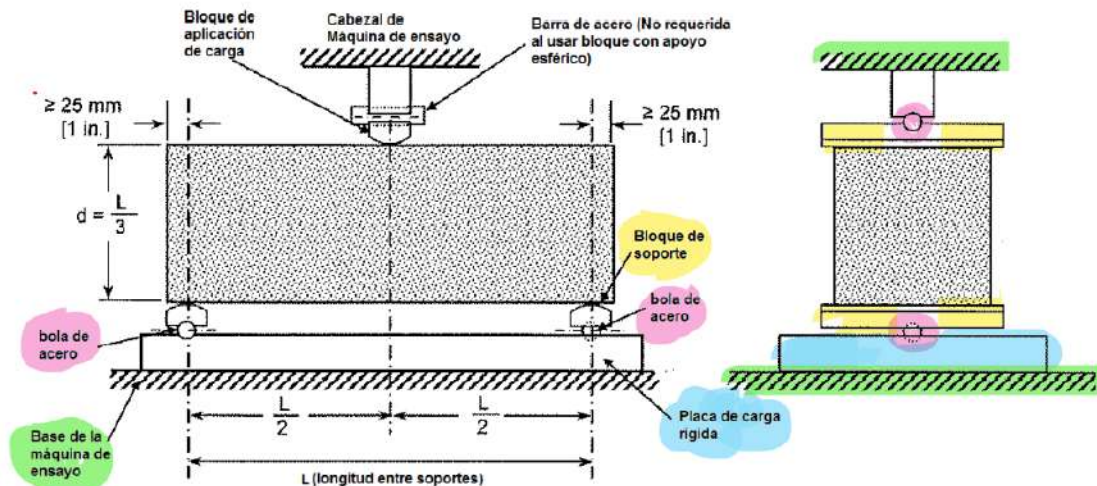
Aparatos para ensayo de flexión en vigas de concreto. Adaptada de ASTM C293-04 [69].
